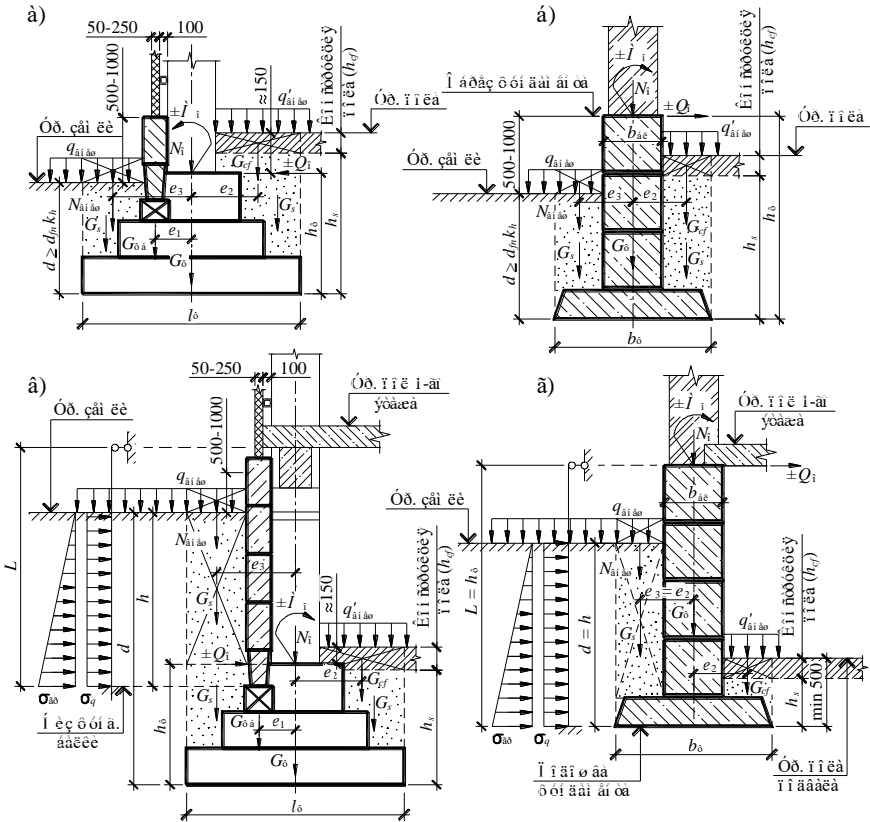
Нагрузки, воспринимаемые подошвой фундамента:
